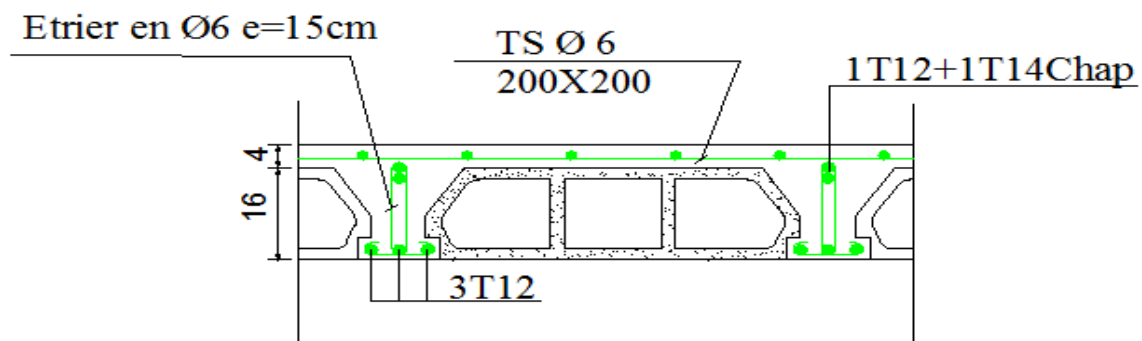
Dessin de ferrailage de la dalle a corps creux.
